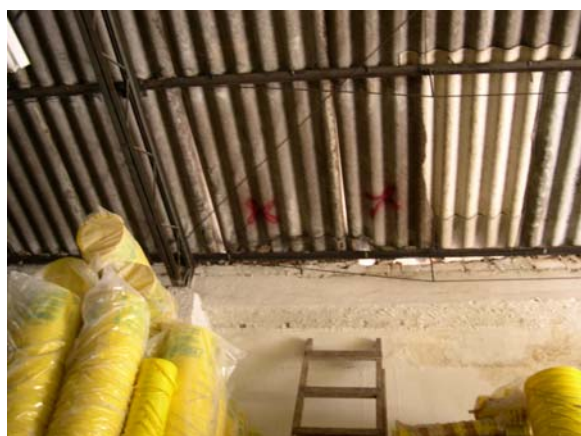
Telhado do galpão da DF Impermeabilizantes. As amostras estão indicadas com “x” vermelho.
